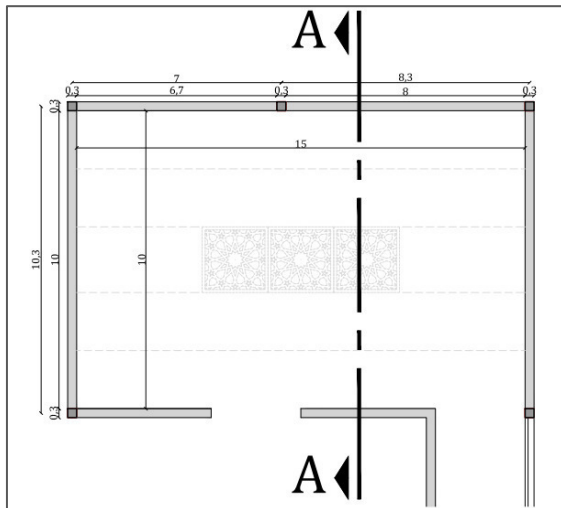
Plan de la salle d'exposition sans mur. (Source : auteur)
